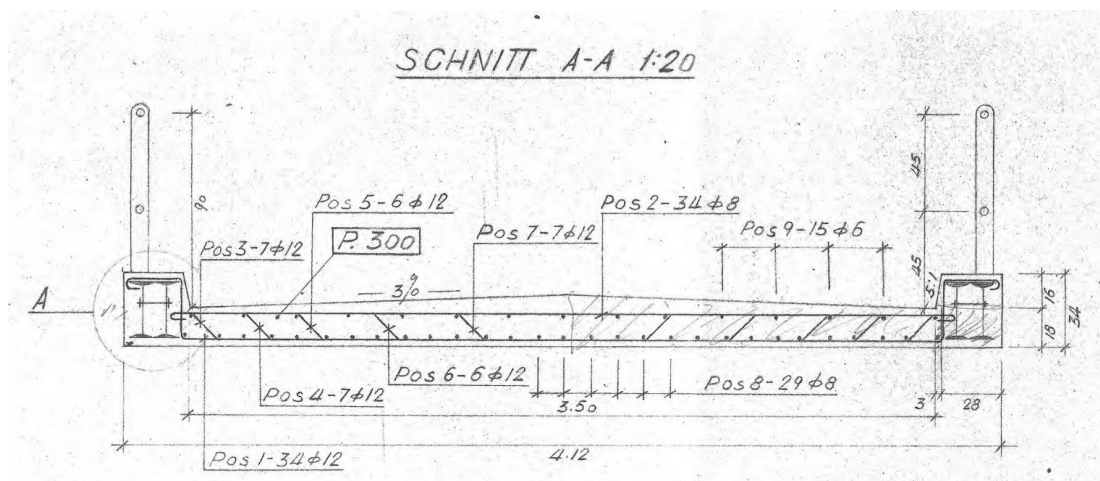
Auszug Ausführungsplan best. Brücke, Schnitt A-A
